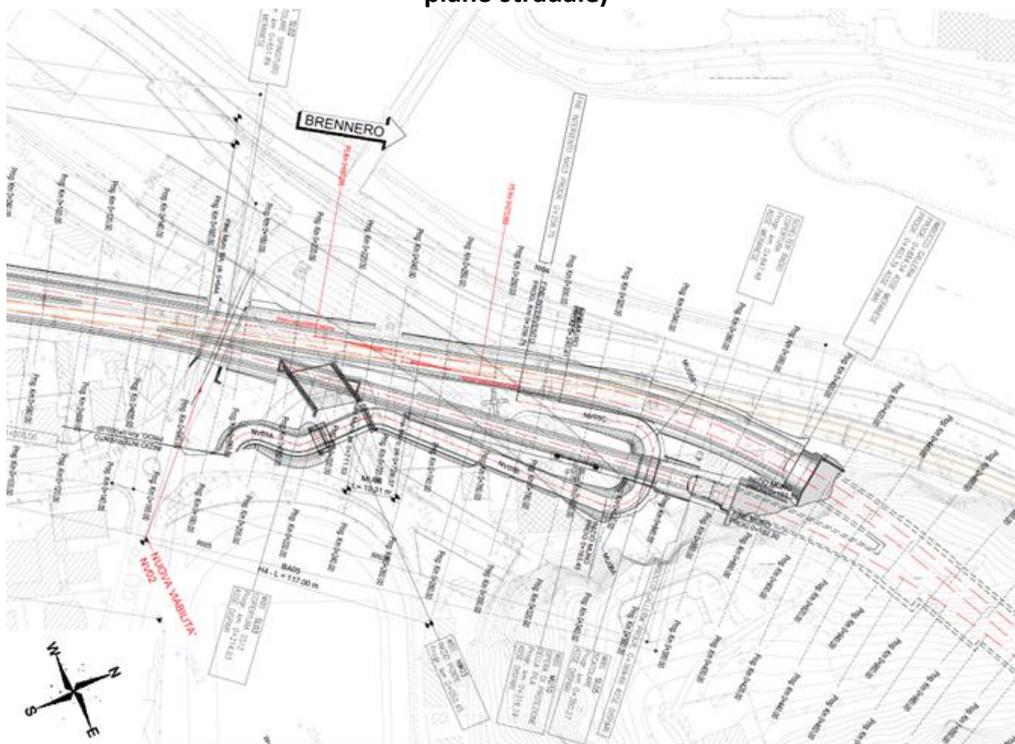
Estratto della Planimetria di progetto da VI01 a Imbocco sud Tunnel del Virgolo
